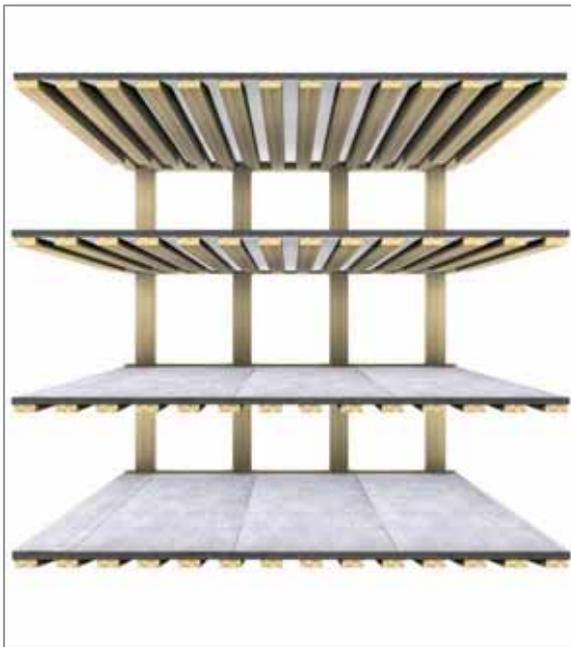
, Tragstruktur mit Holzrippen und Stahlbetondecke
